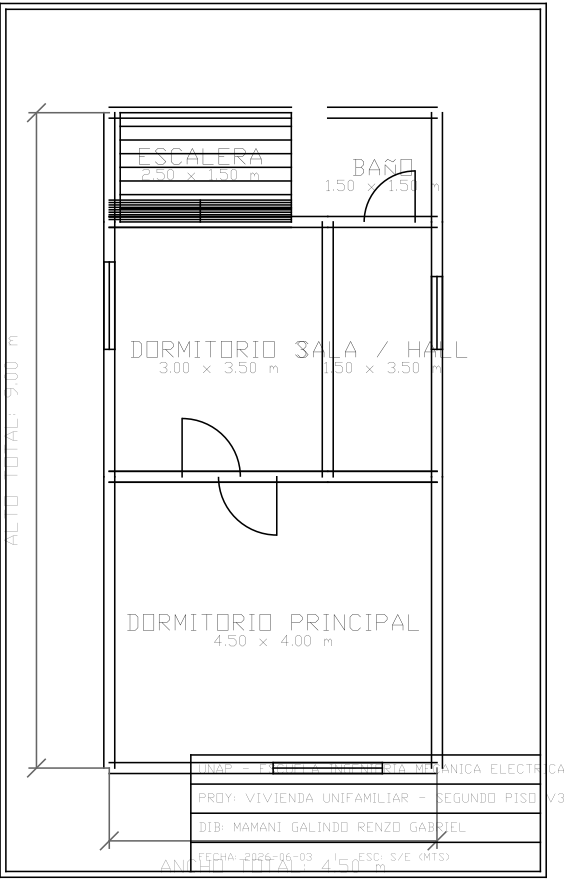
Plano de Distribución Arquitectónica - Segundo Piso
